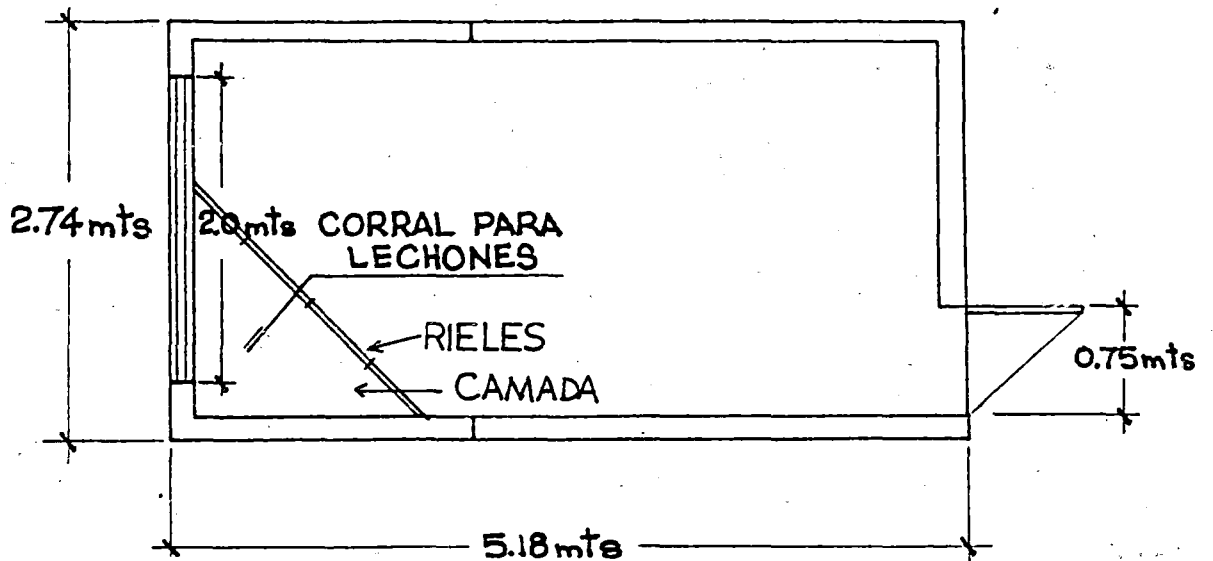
VISTA EN PLANTA DE CORRAL DE CRIA.
